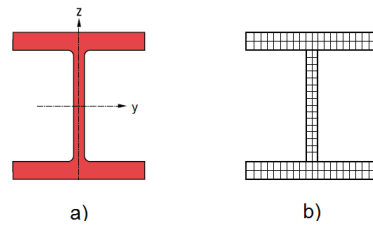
a) Perfil em I b) Exemplo de uma secção de fibras do perfil I.
